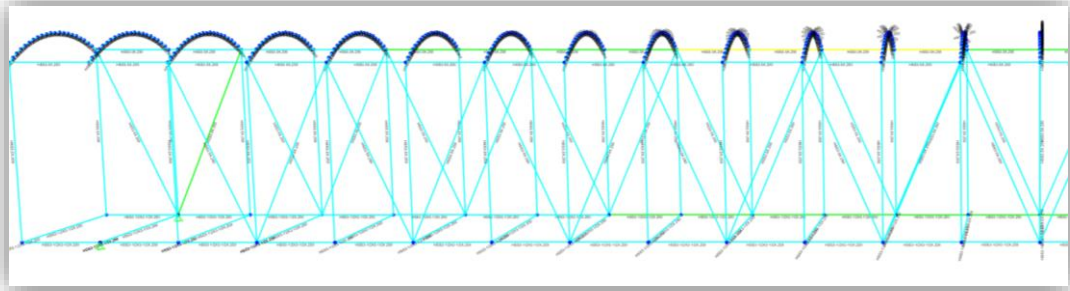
Análisis Estructura Central (Apoyo: Pasador).
